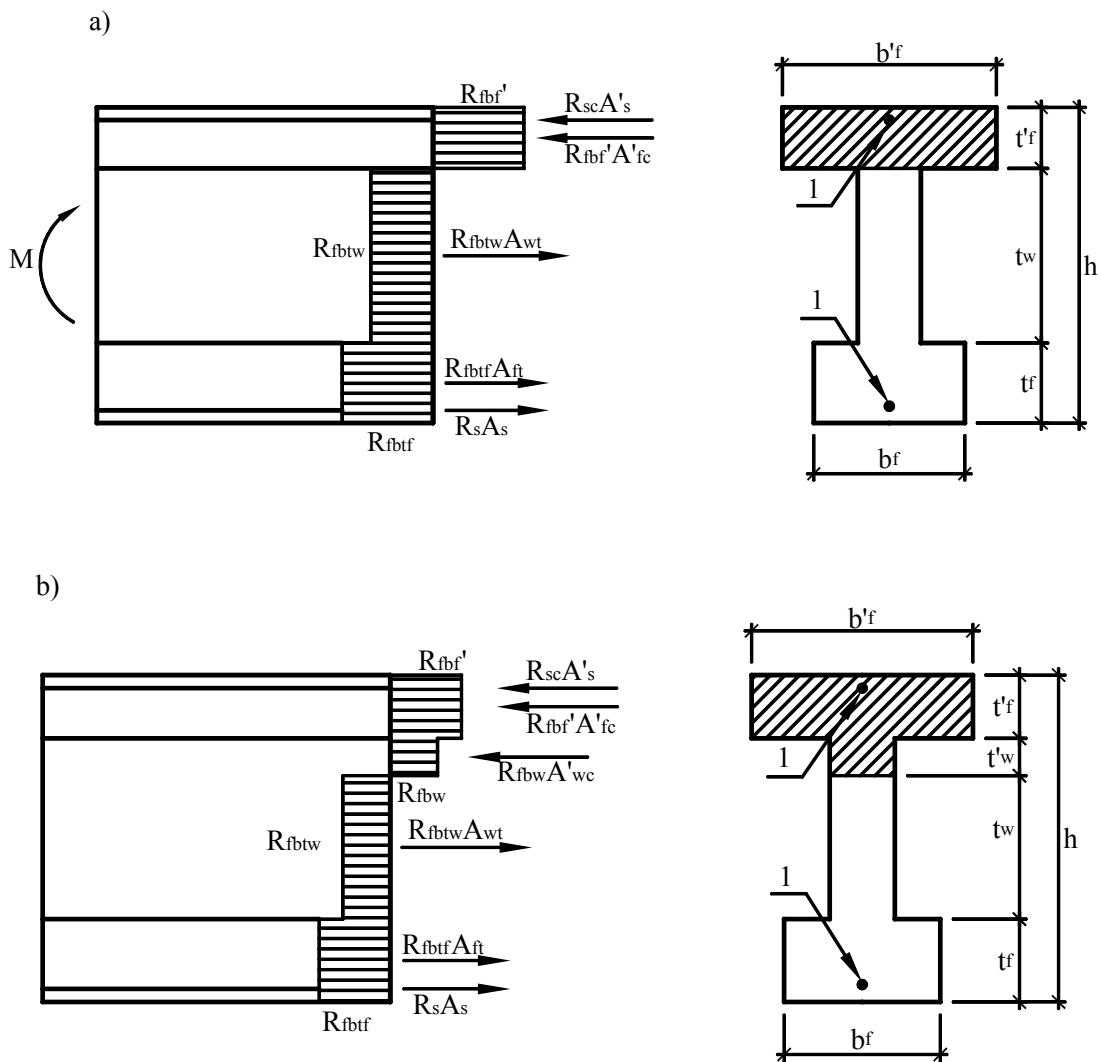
Схема распределения усилий и эпюра напряжений в сечениях, нормальных к продольной оси изгибающего элемента двутаврового сечения при комбинированном армировании
